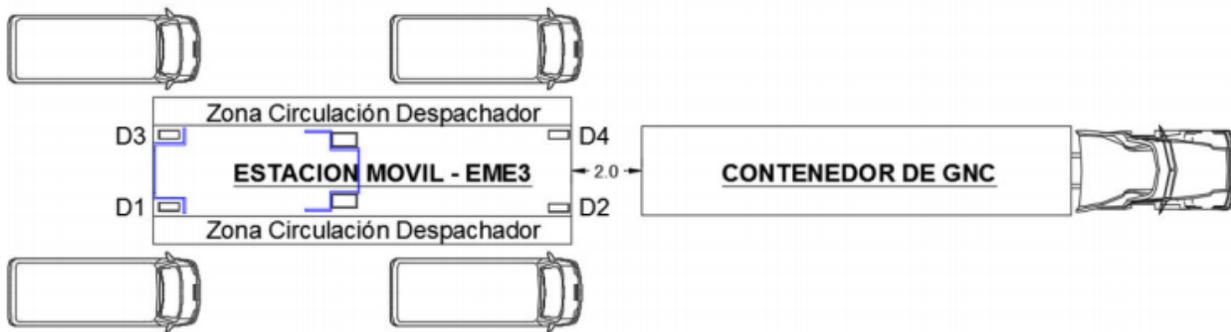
Esquema de posicionamiento adecuado para el despacho
